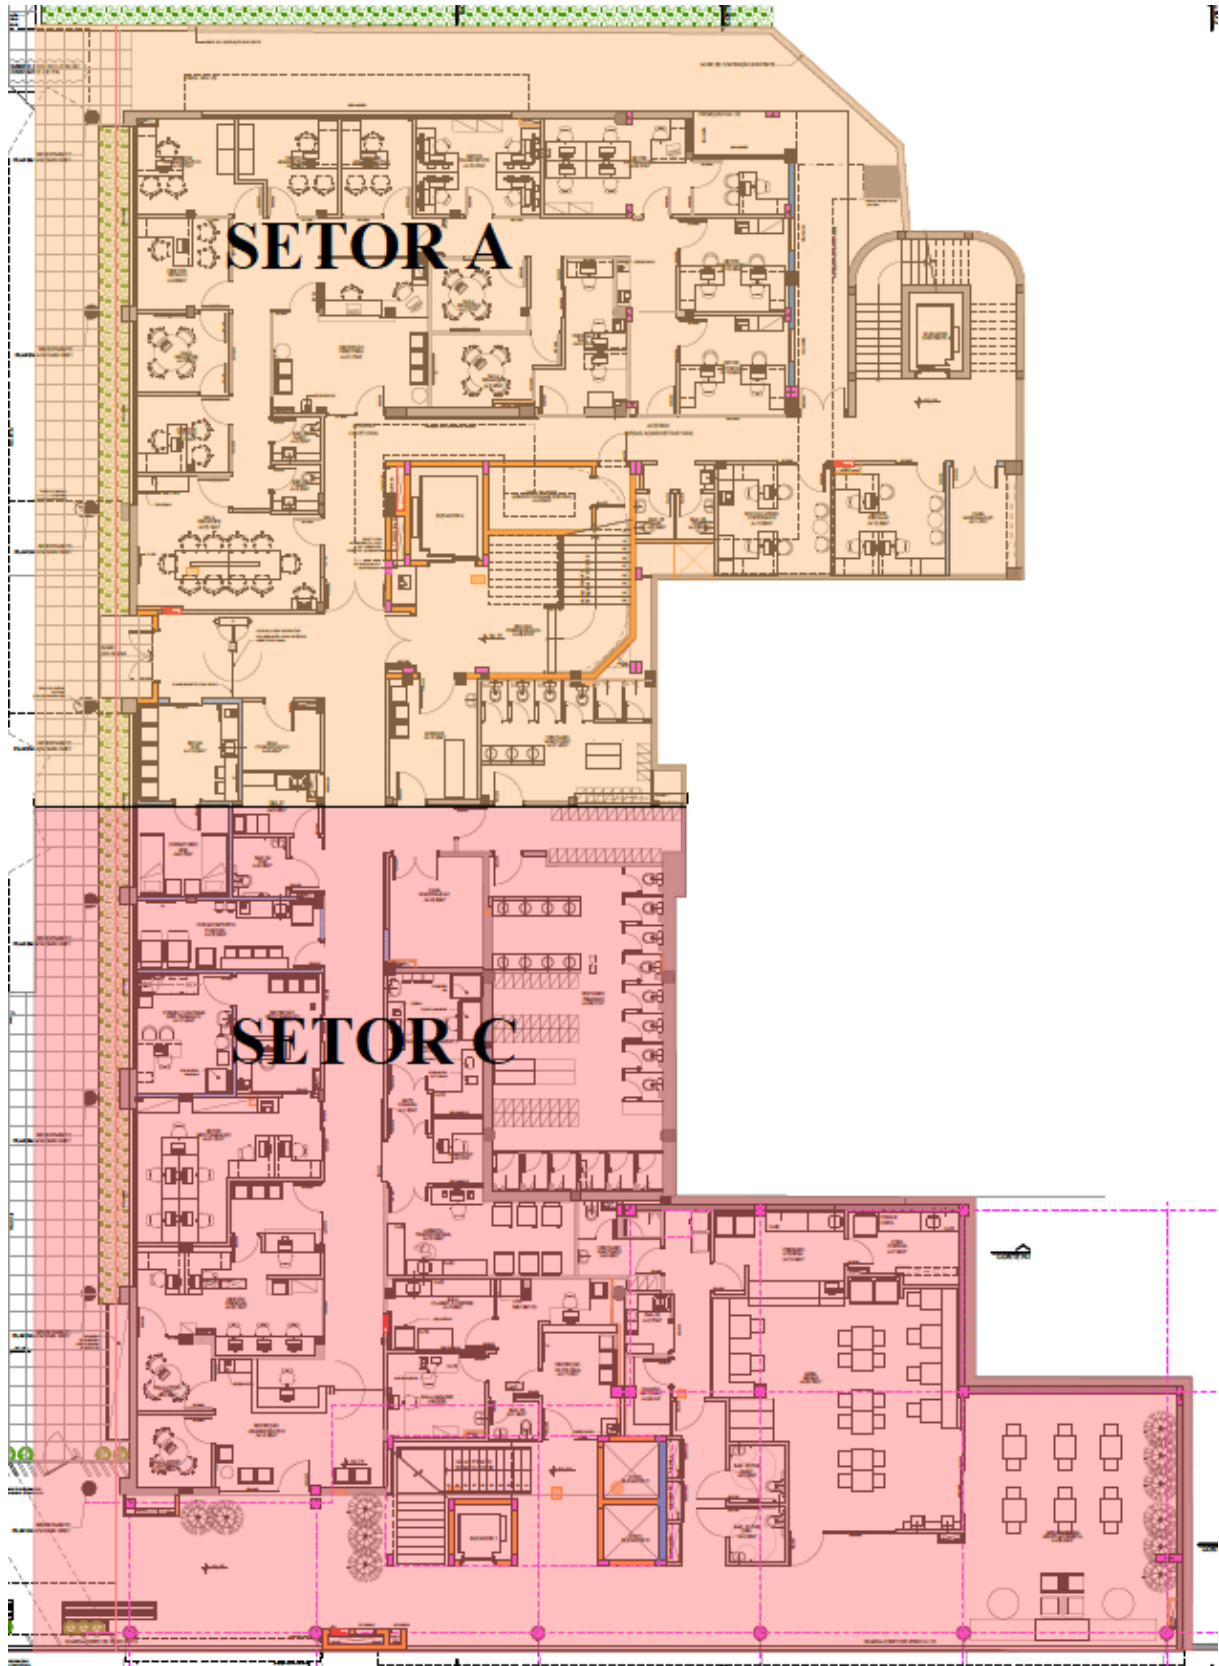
Zonas de trabalho existente na obra – Pavimento Térreo
